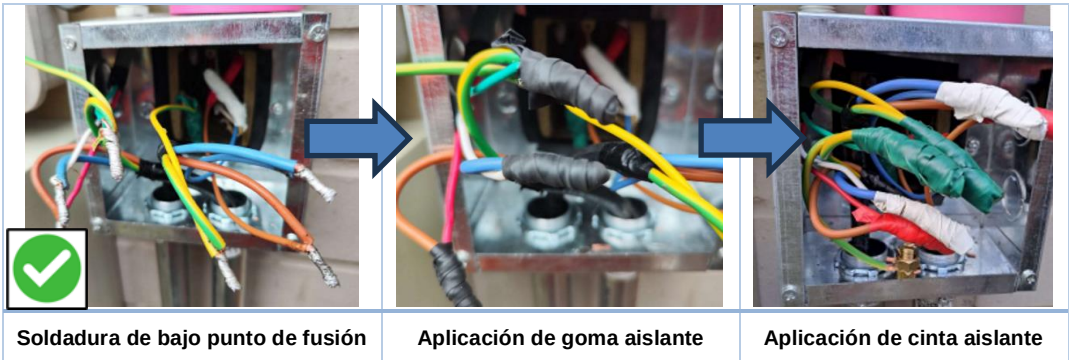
Unión por soldadura de bajo punto de fusión.
